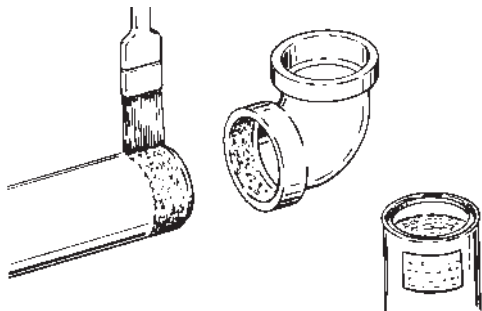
Étape E – Application de la colle de soudure à froid
